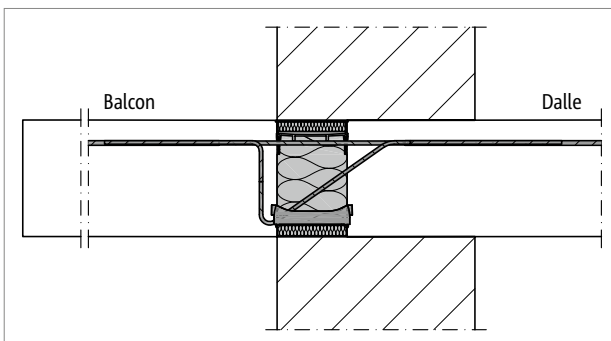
Schöck Isokorb® TX Type K : Raccordement sur maçonnerie monocoque
